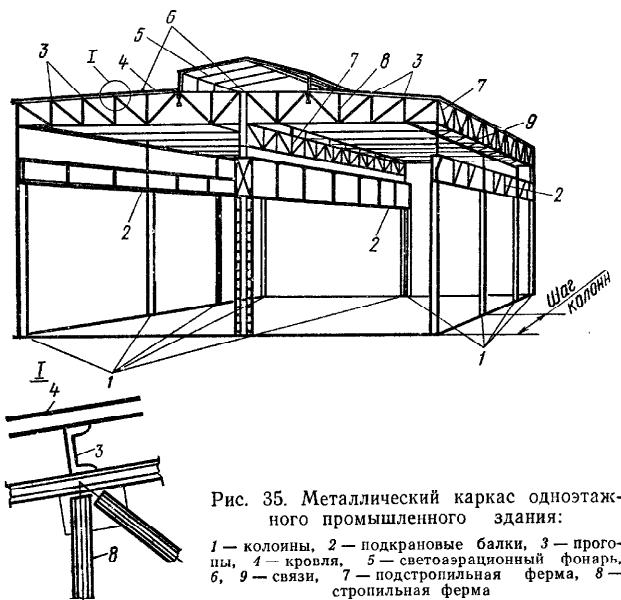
Металлический каркас одноэтажного промышленного здания:
